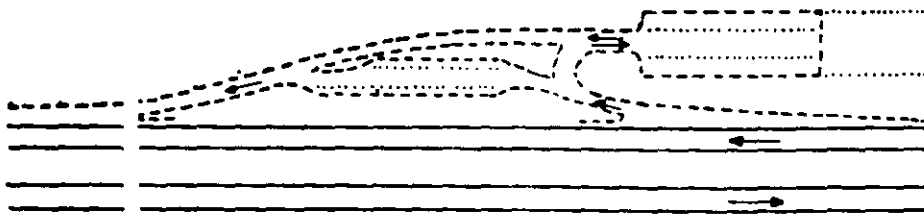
ZONA DE DESCANSO PARA ESTACIONAMIENTO SEPARADO PARA AUTOMOVILES Y CAMIONES
